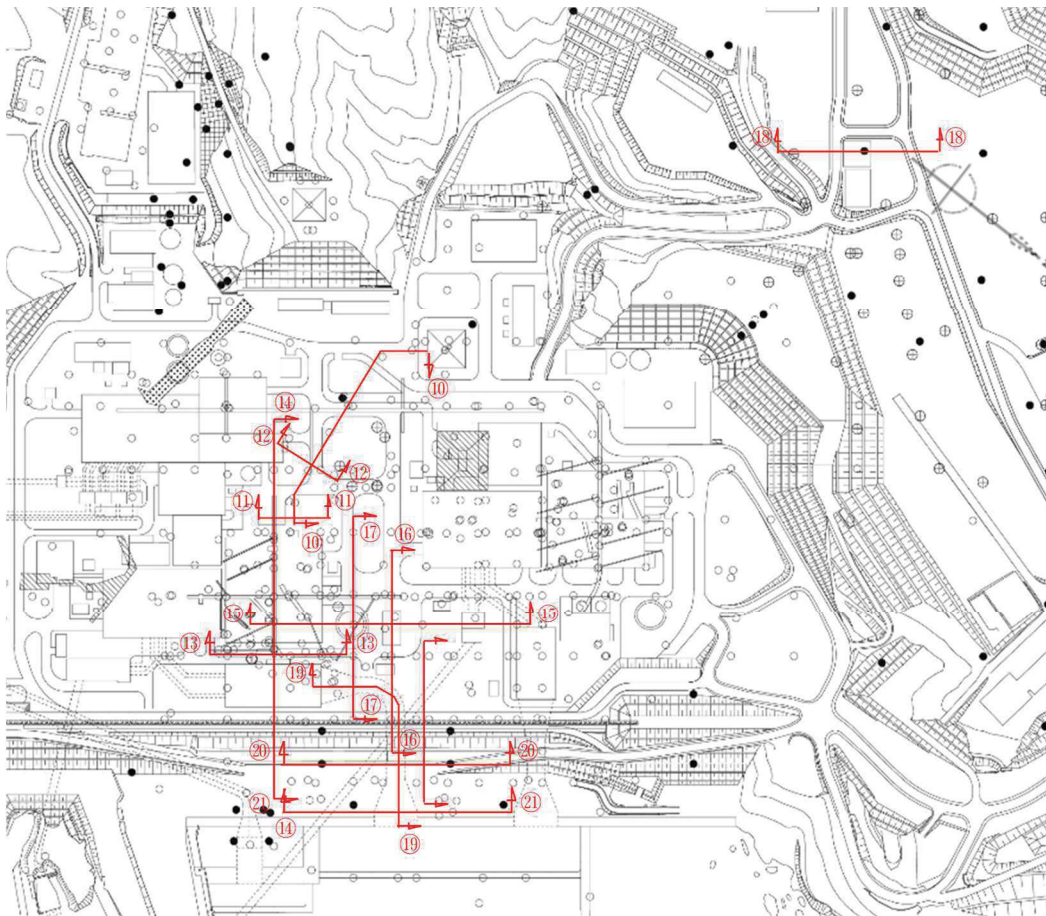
(2) 地質断面图位置 (⑩-⑩断面~㉑-㉑断面)
